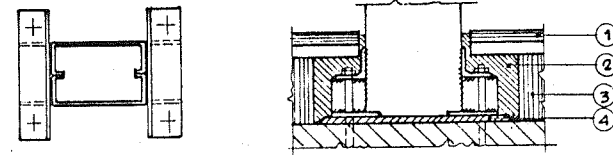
Columna de chapa doblada: base articulada (ref. 5.57)
